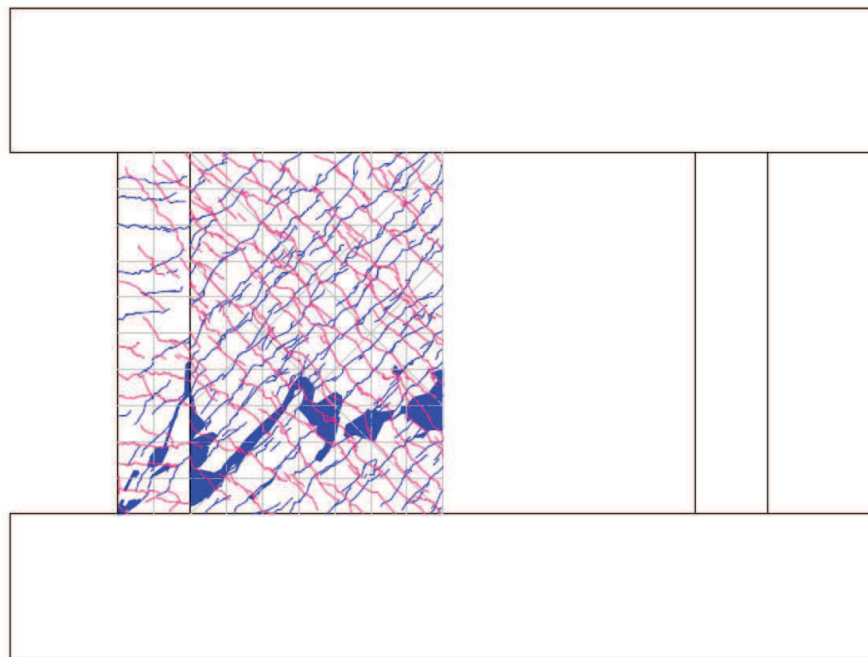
試験体 S-13-D0 最終破壊時ひび割れ図
